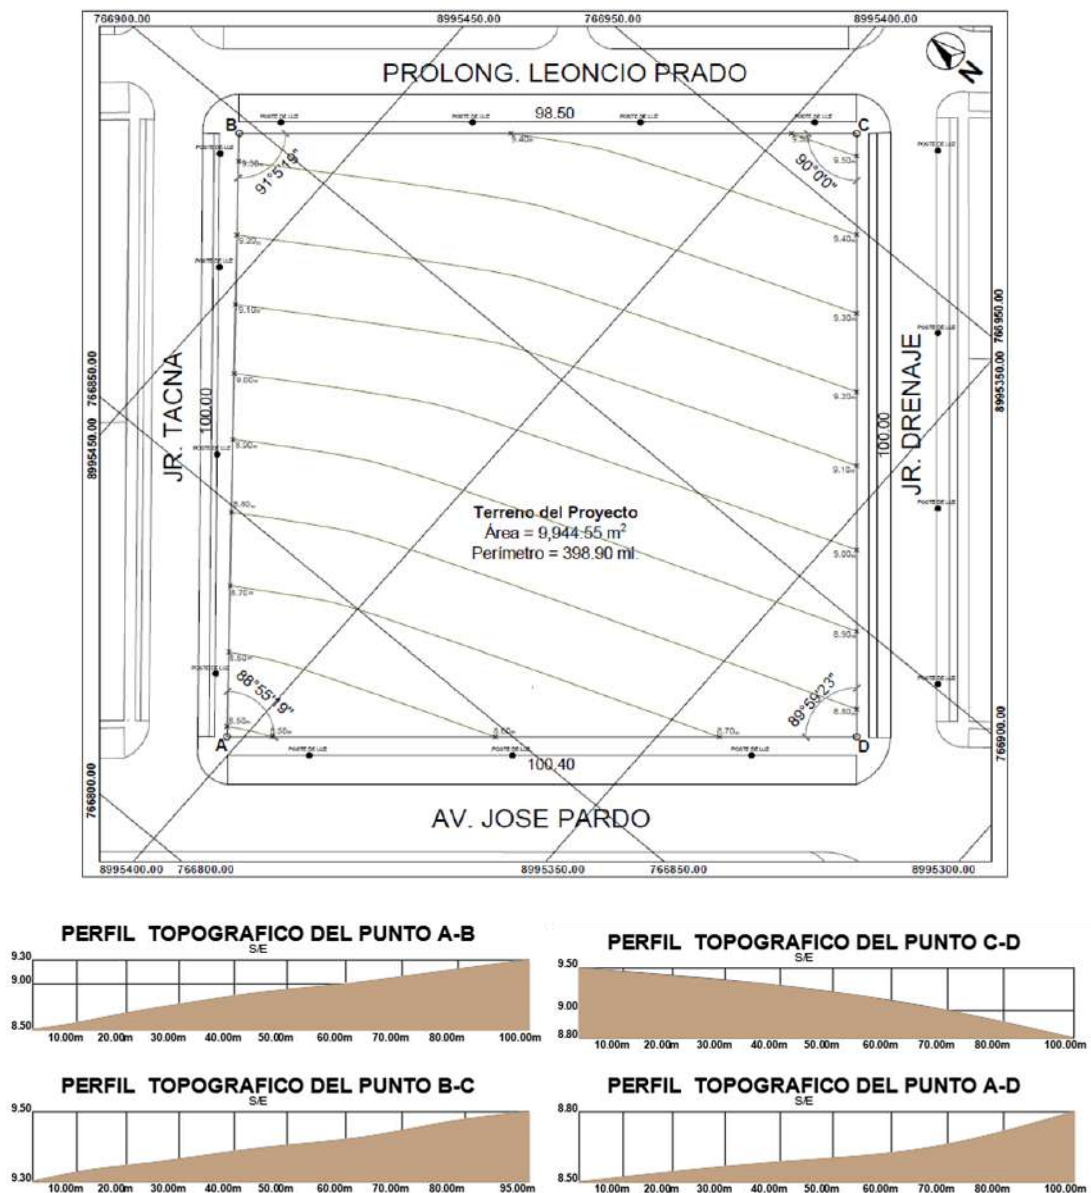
PLANO TOPOGRAFICO Y PERIMETRAL DEL TERRENO.
